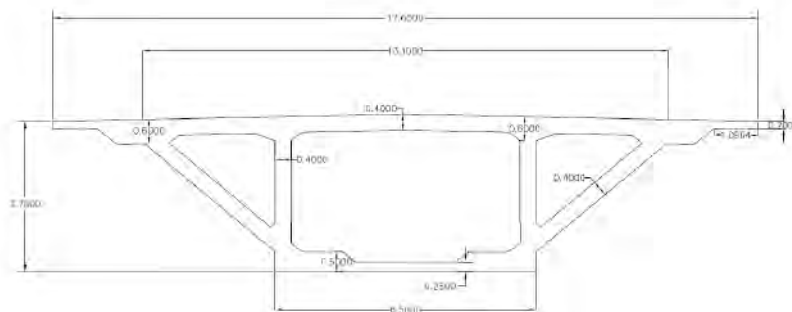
Sección Transversal del Tablero Tramo Extradosado. Alternativa Puente Extradosado
